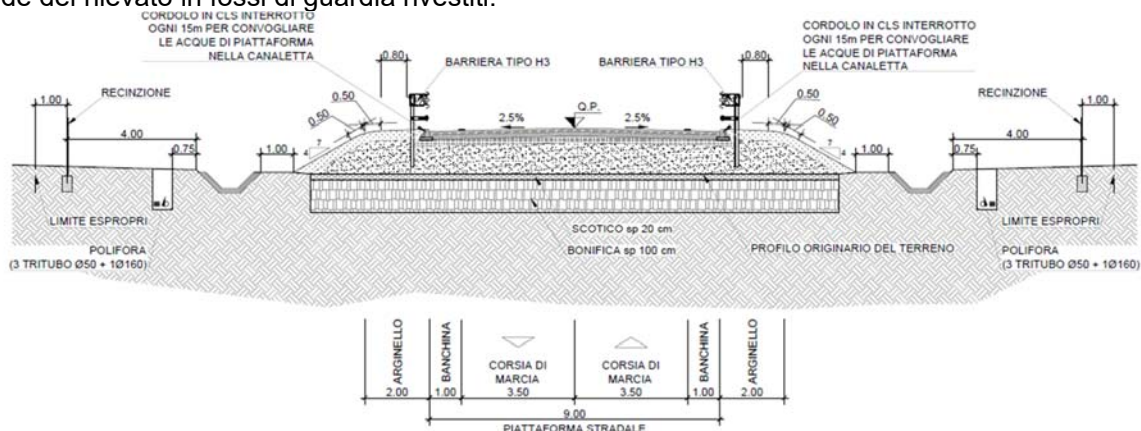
Sezione tipo rami di svincolo in rilevato rampa bidirezionale
